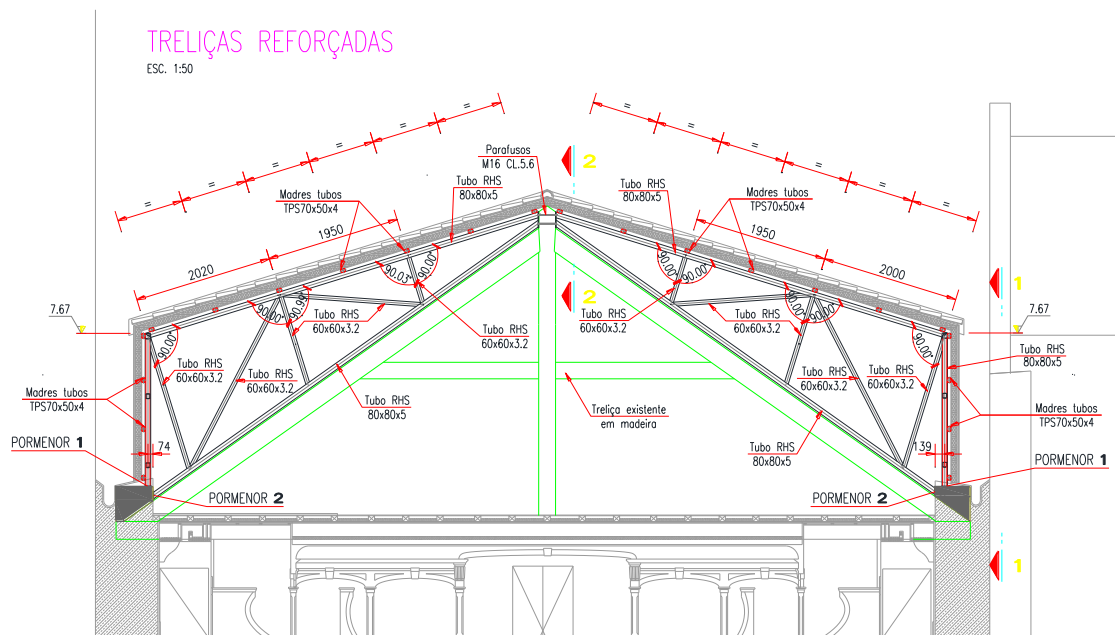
Reforço da cobertura de madeira da zona da entrada e da zona da plateia (corte transversal das treliças de madeira reforçadas, s/ escala)
